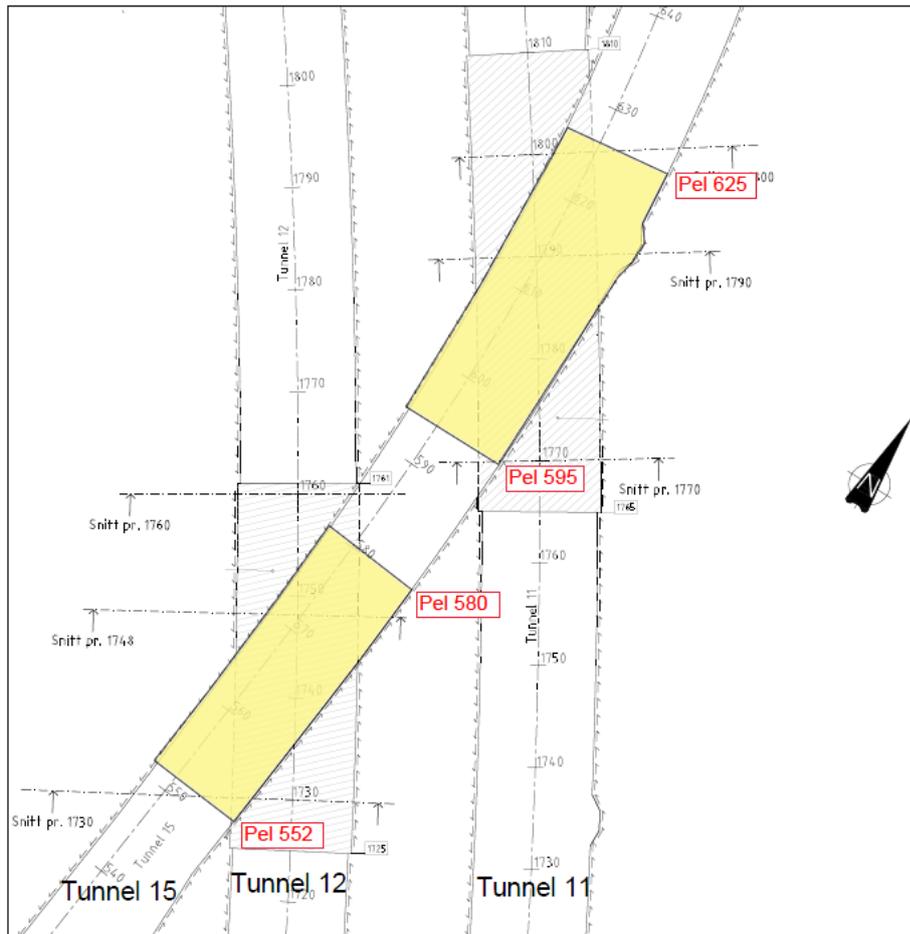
Skisse over hevet såle i tunnel 15 over tunnel 11 og 12.
